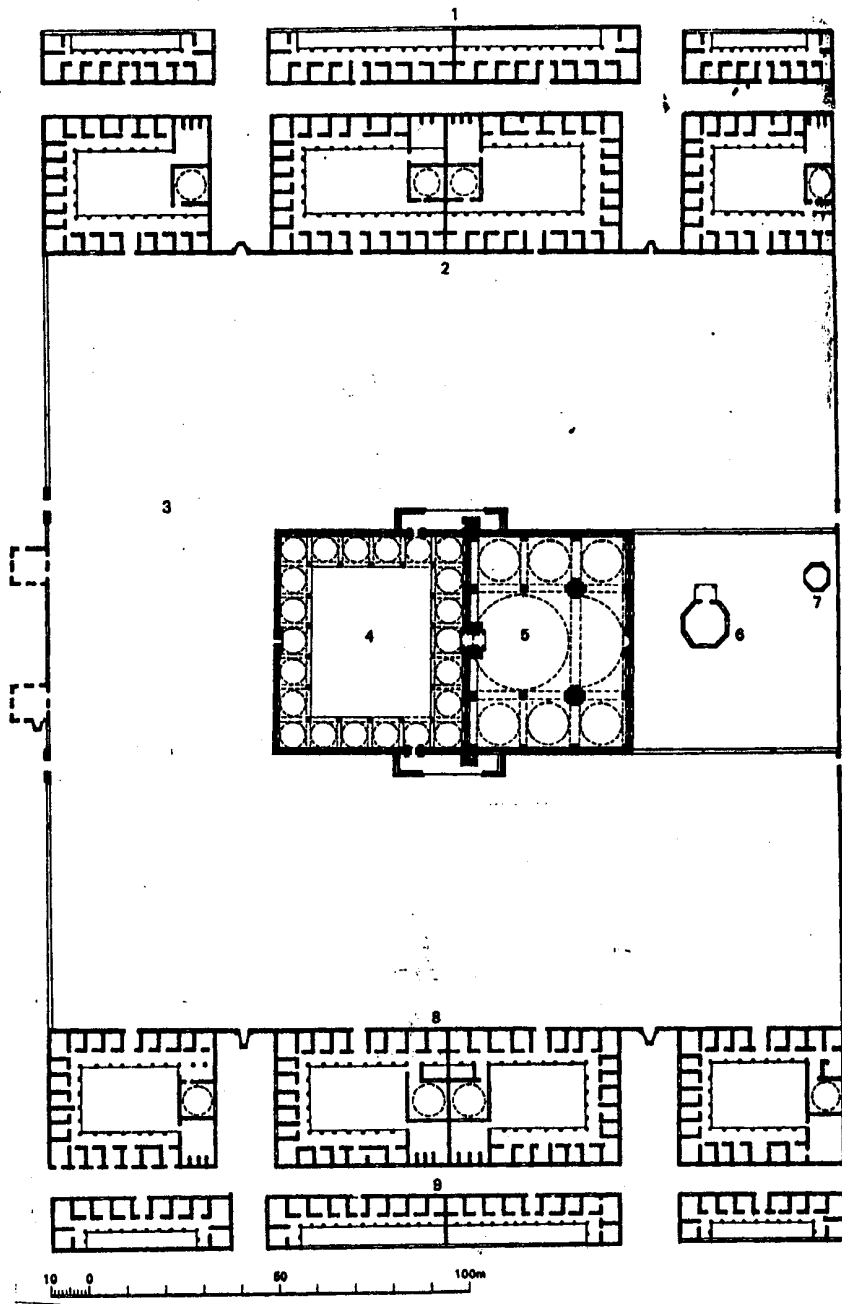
مسقط أفقي لمدرسة السلطان بايزيد في أماسيا
